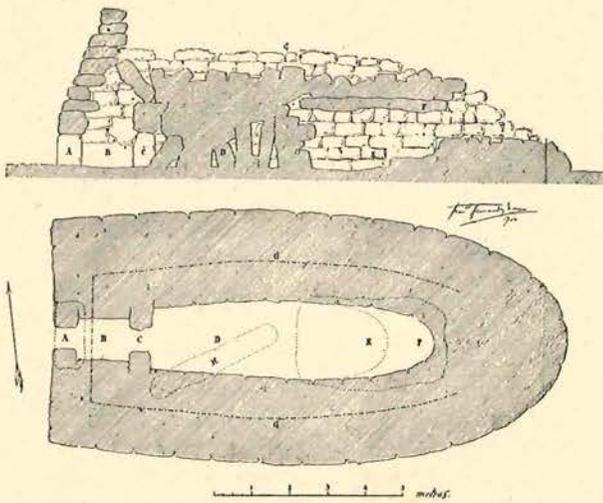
NAUETA D'ES TUDONS. — Coupe et plan.
